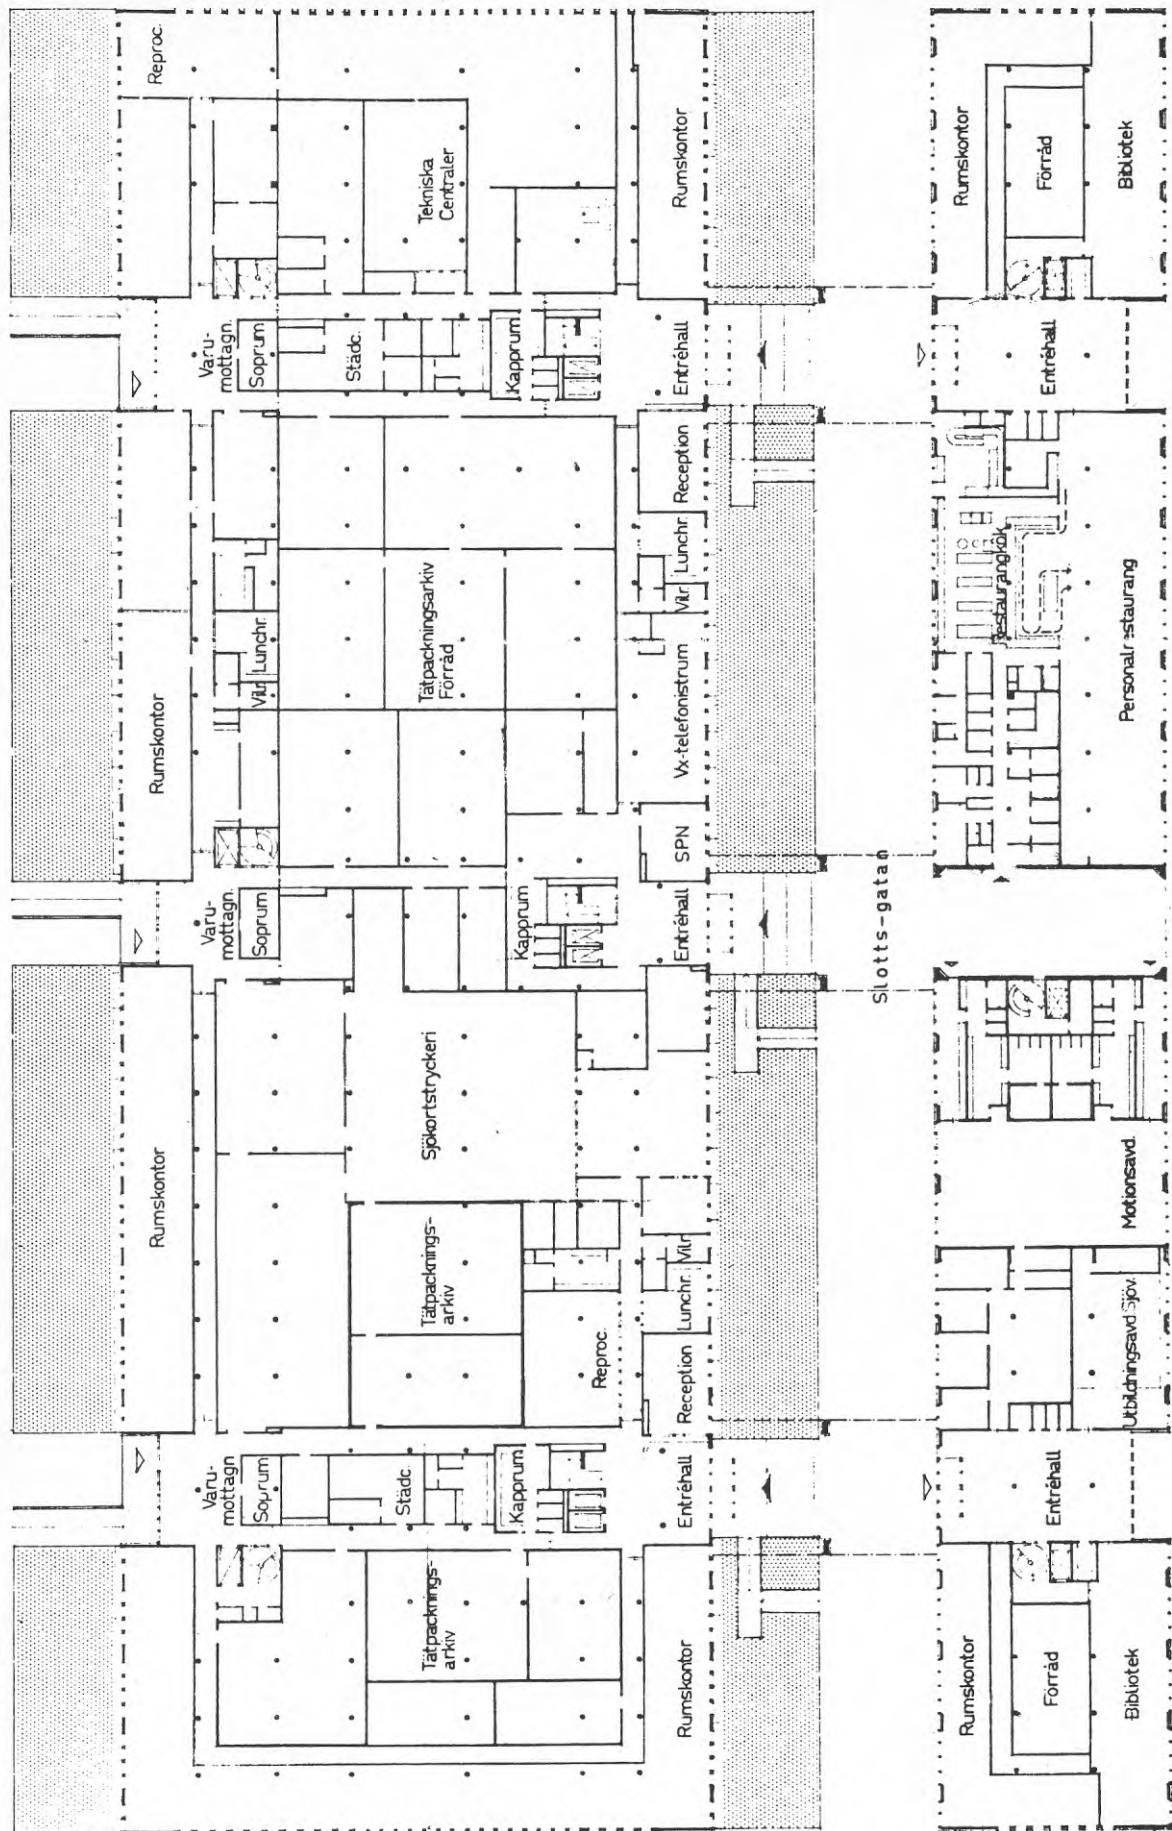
Plan 1. Anmälningshandlingar, 1972 sommaren.
